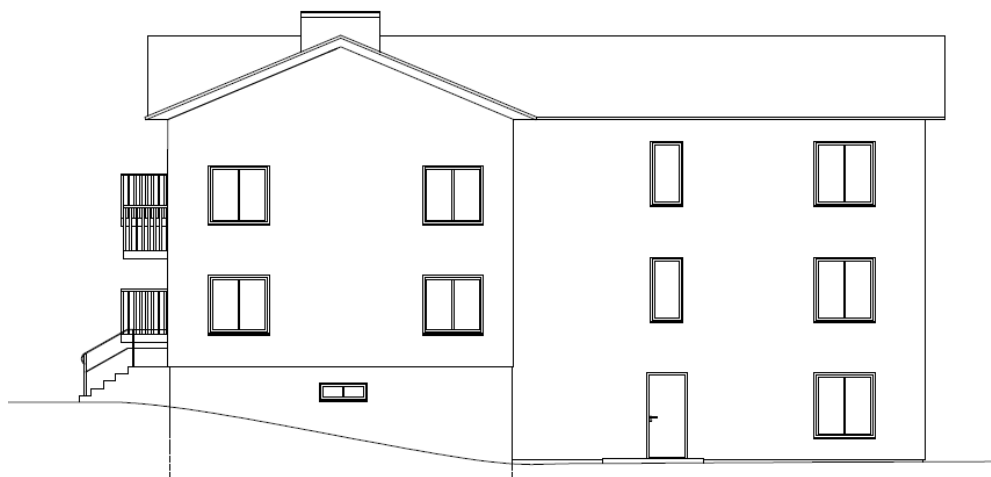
Bild som visar fasad mot öst. Befintlig byggnad i förgrunden och föreslagen tillbyggnad i bakgrunden.
